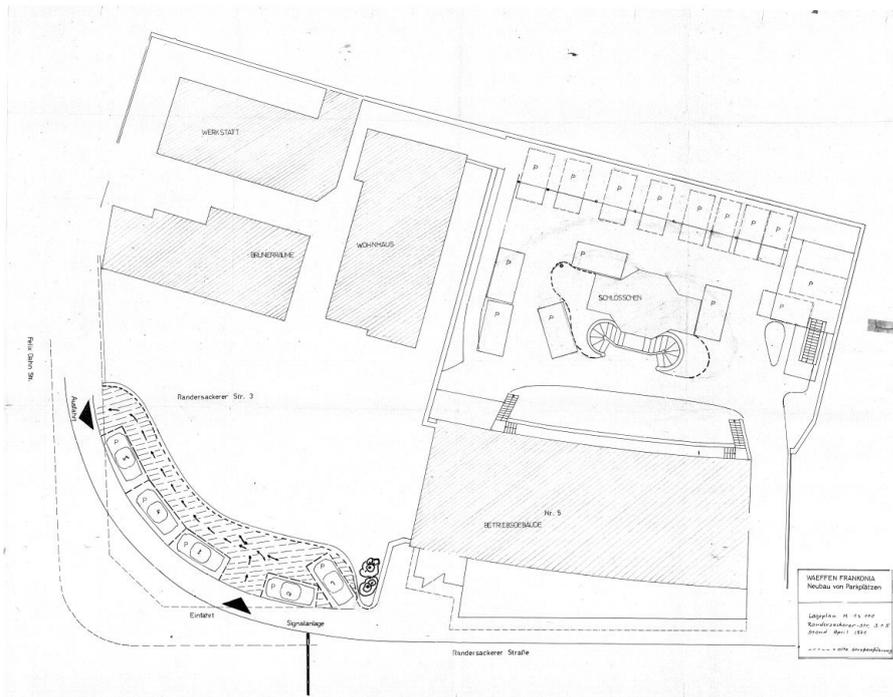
Lageplan, Neubau von Parkplätzen, April 1971.
